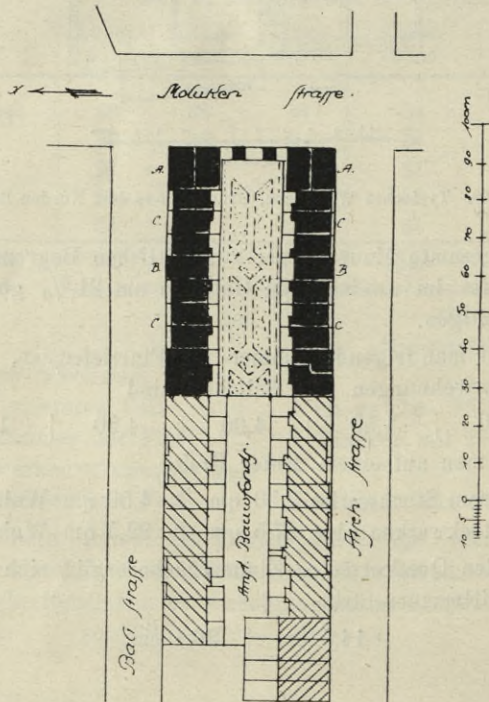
Bebauungsplan der Baugesellschaft Rochdale, Amsterdam
